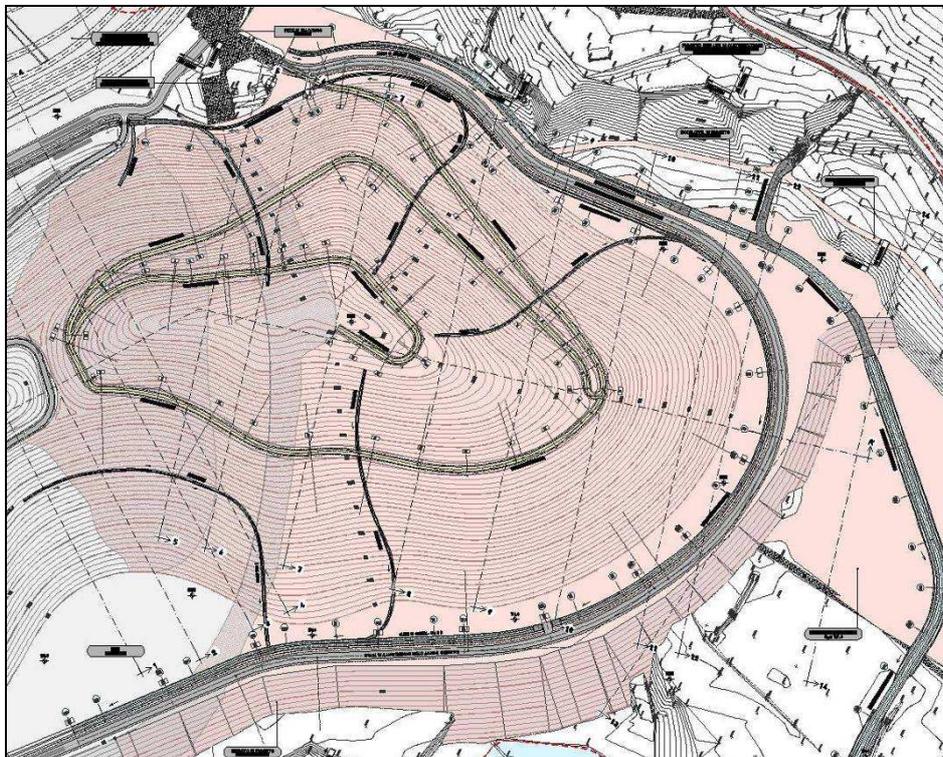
Stralcio planimetrico viabilità di manutenzione e fruibilità
